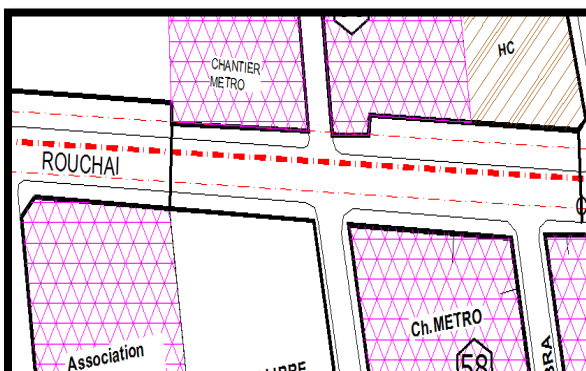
Vue en plan sur la station métro avant l'intervention.
